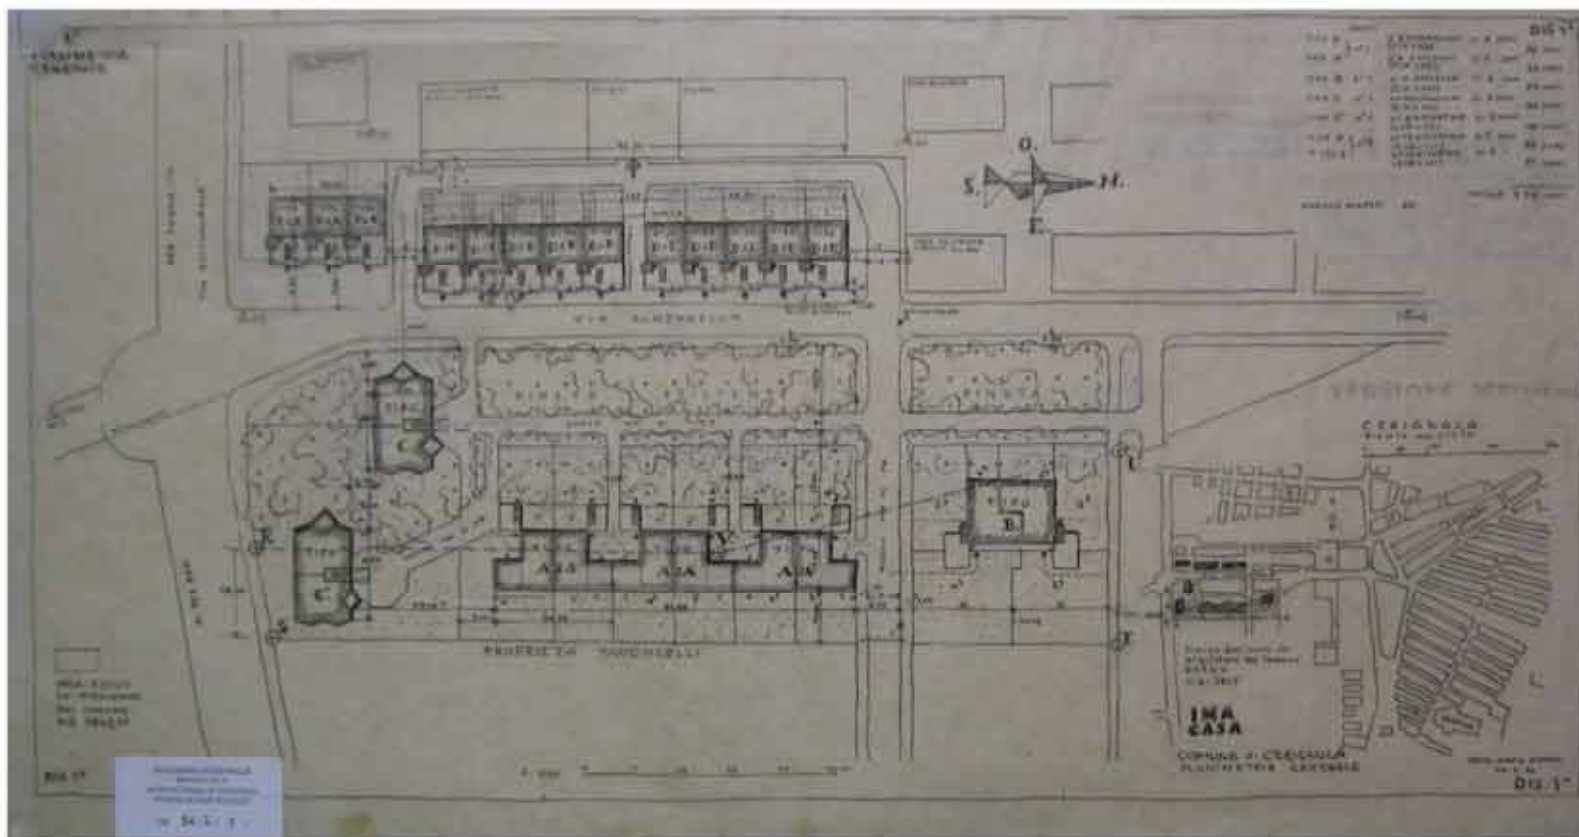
disegni generali/soluzione definitiva/ planimetria generale
